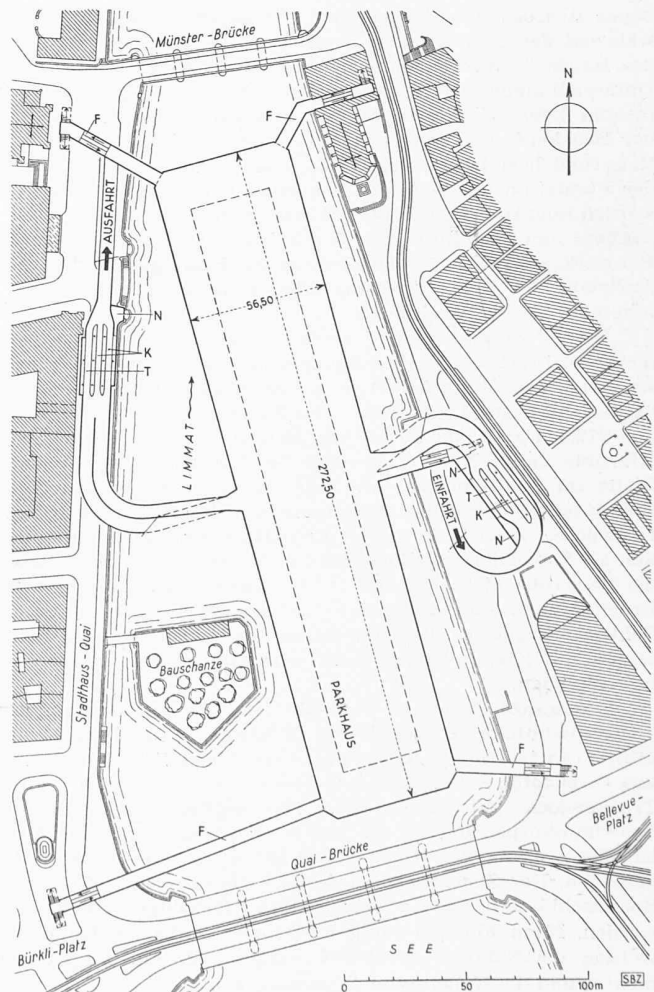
Lageplan 1:3000 mit den Autorampen (gestrichelt zum Unterschoss) und Fussgängertunneln F. K Kasse, T Tankstelle, N Nebenräume
